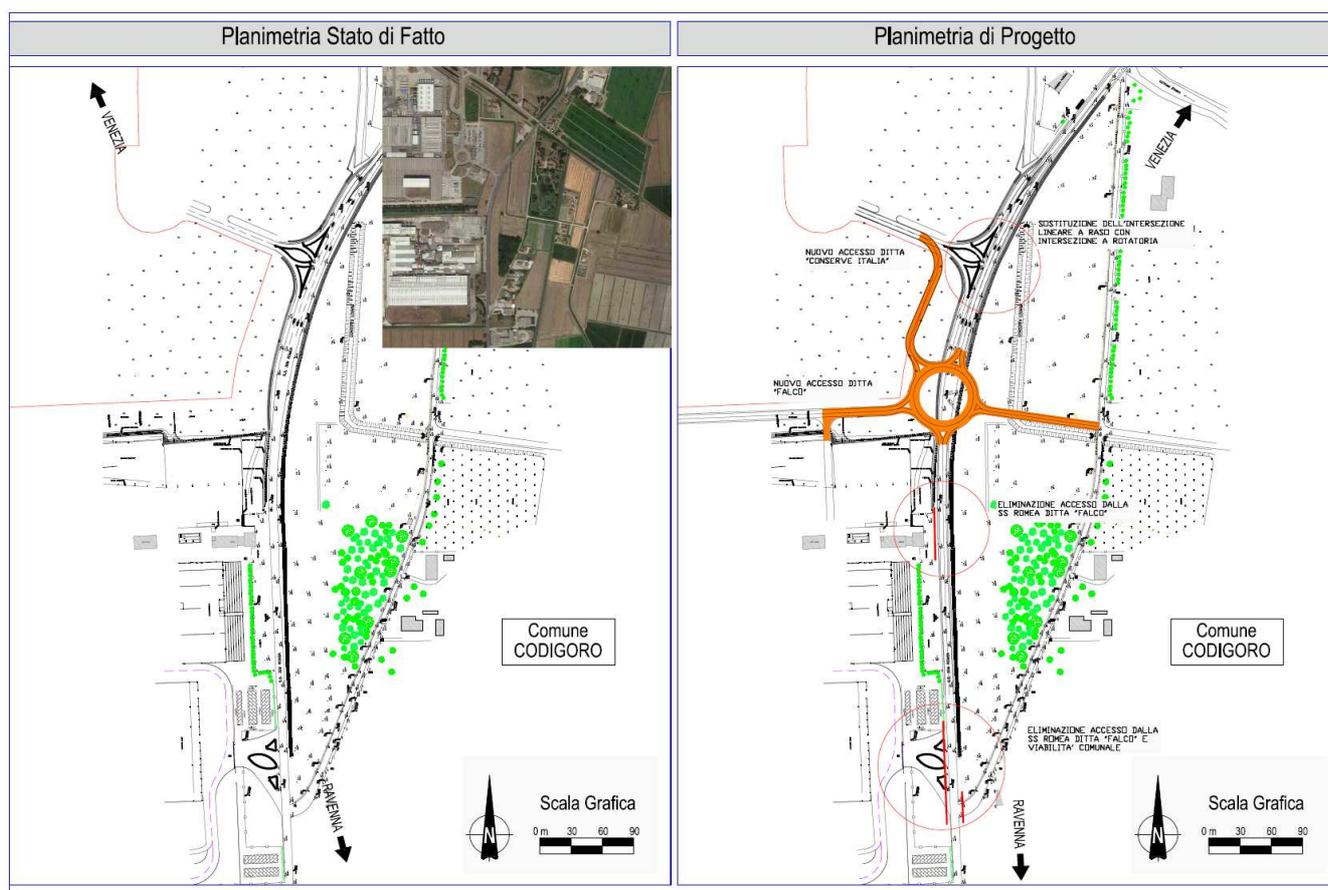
Intervento n° 18 – Planimetria Stato di fatto - Progetto
